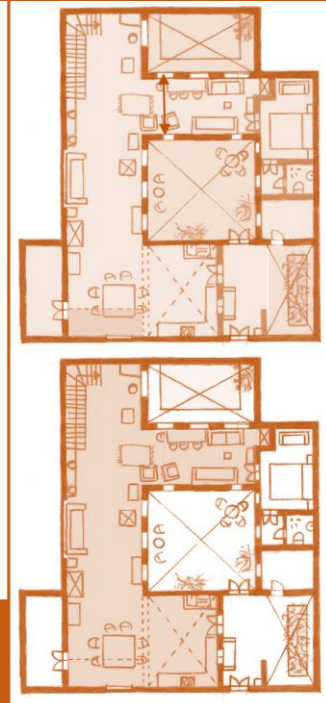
Croquis du plan du rez-de-chaussée dar Lotfi & Inès Abdelli
